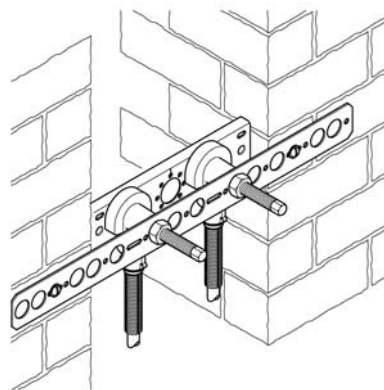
Montaje con plantilla WEKA (disponible en ferreterías)
